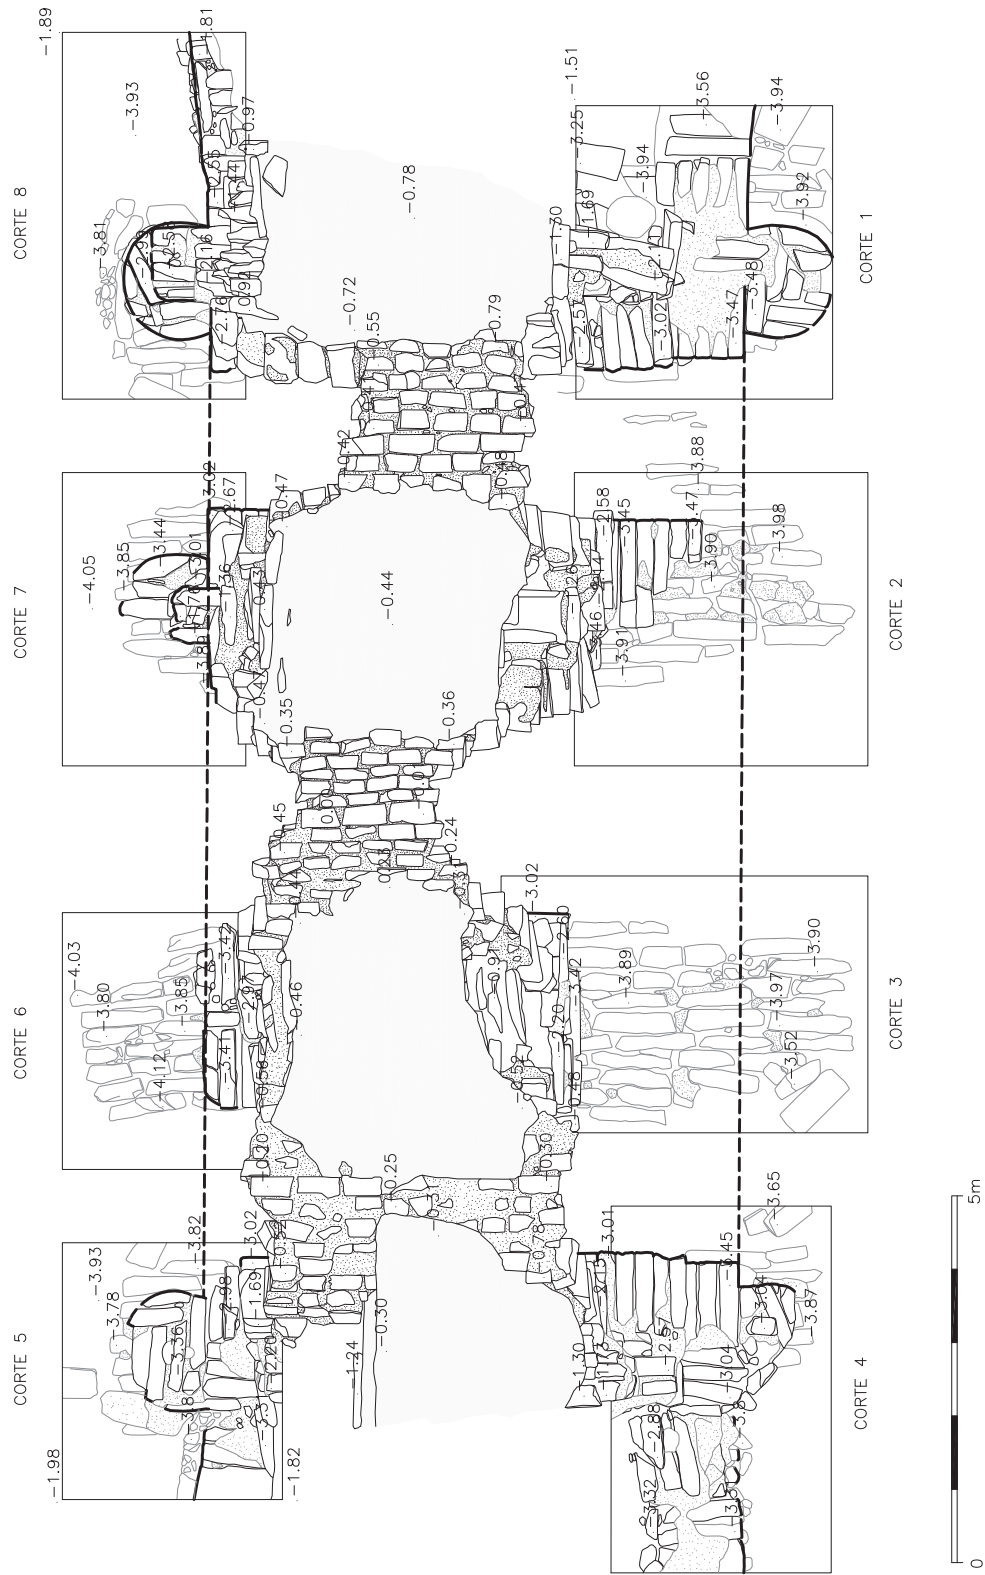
Planta del puente de los Nogales con situación de los cortes, estado previo (resaltado) y ancho del tablero (discontinuo).
